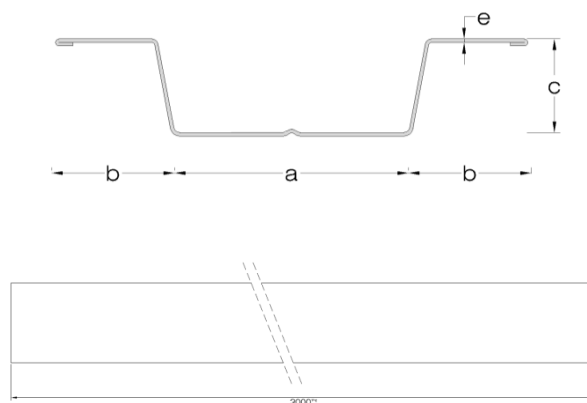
Perfil omega maestra. FUENTE: Weber Saint-Gobain. (36)
